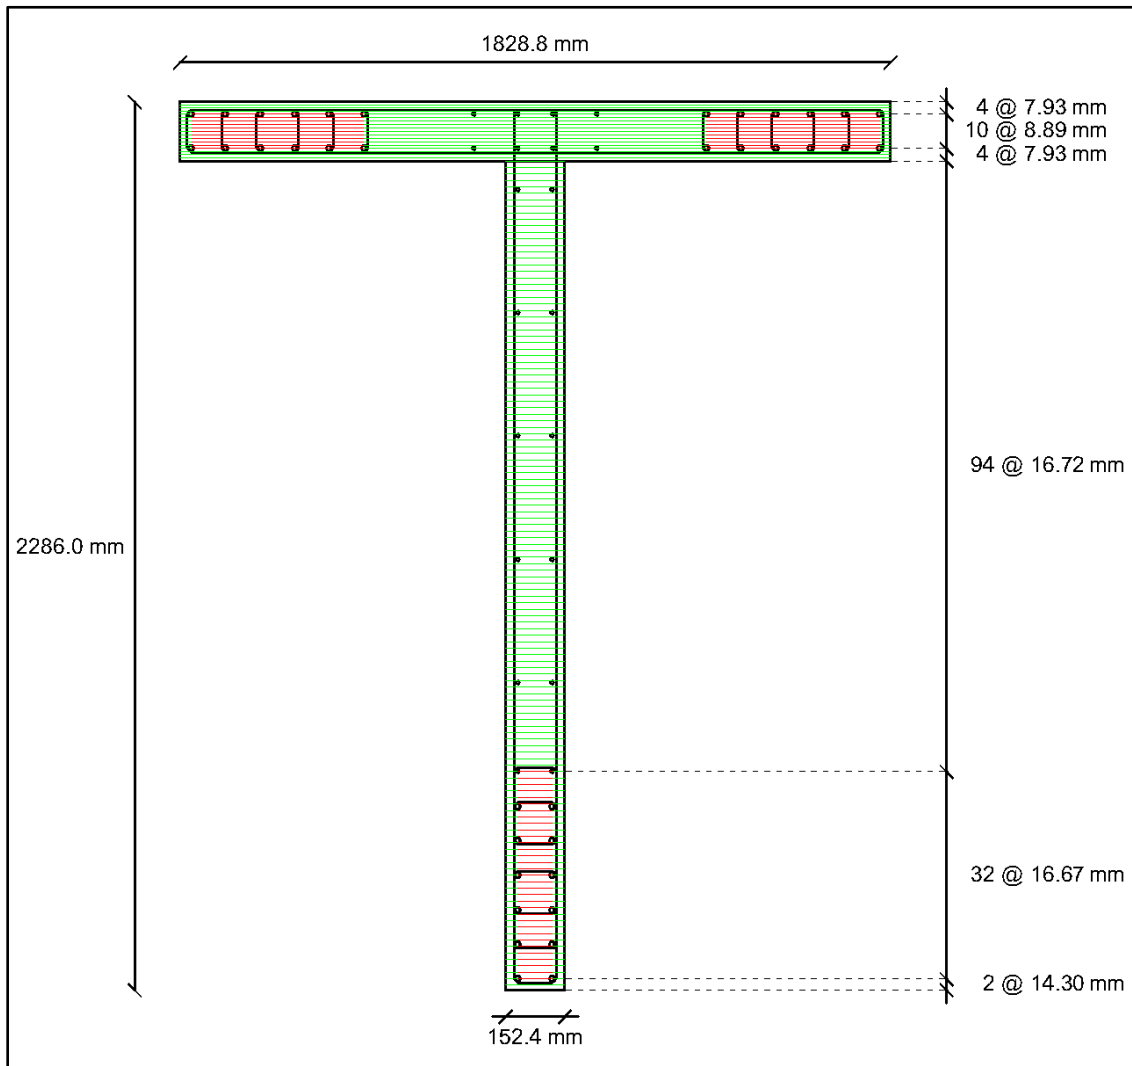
Discretización en fibras de la sección transversal del muro NTW1.
